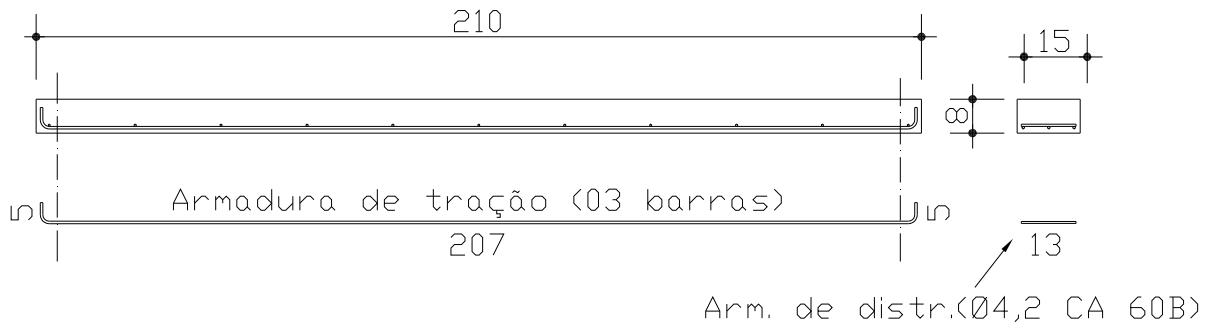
dimensões das vigas e configuração básica da armadura utilizada
